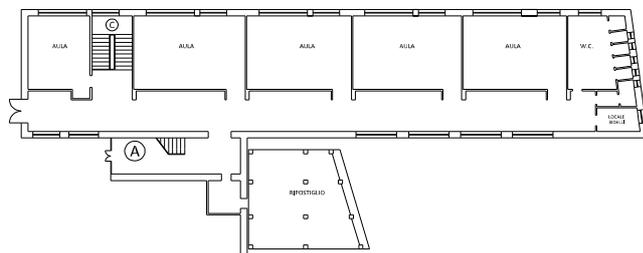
6: Pianta piano secondo seminterrato (blocco aule 2).
